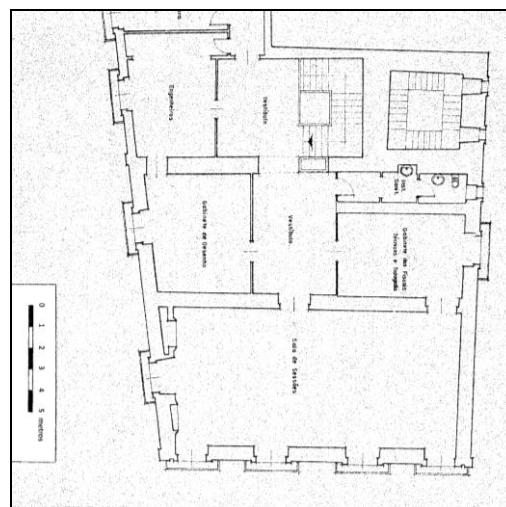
Casa de câmara e cadeia de Ponta Delgada – planta do terceiro piso.
